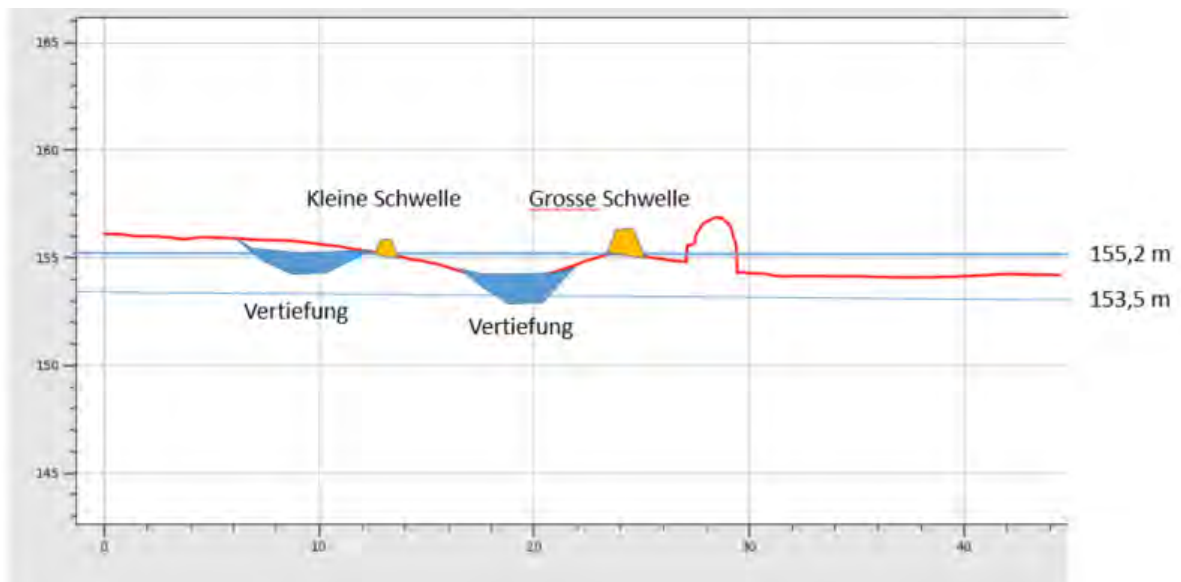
Profilschnitt nach Vermessung 10.10.2022 und geplante Vertiefungen
